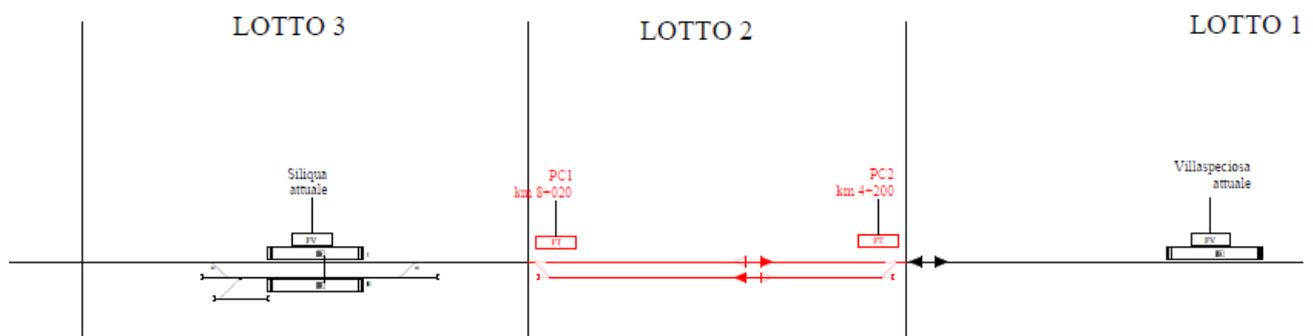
Stralcio layout funzionale di progetto (km LS)
